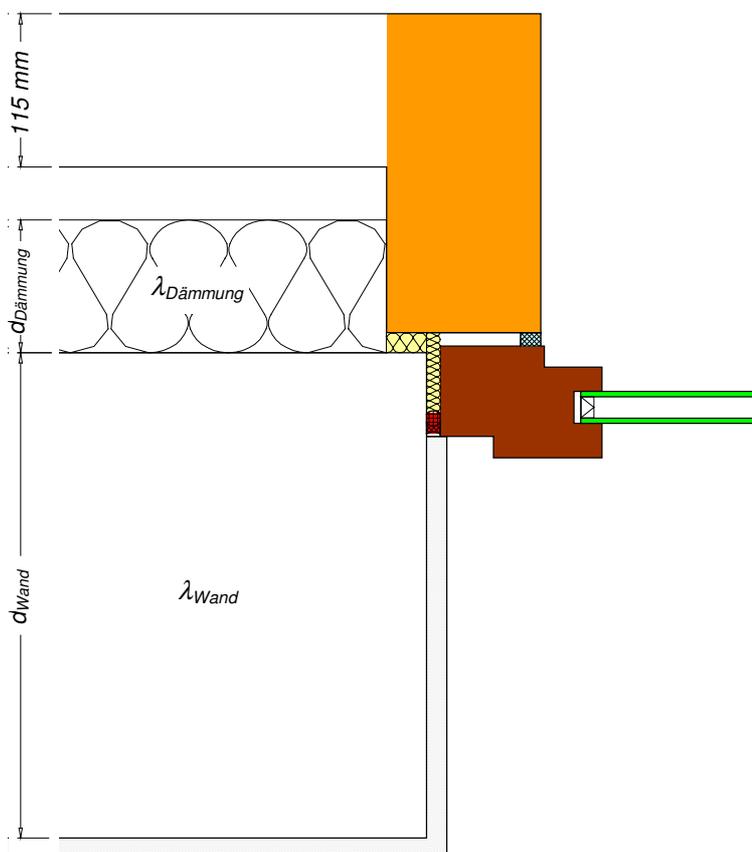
Seitlicher Baukörperanschluss eines Fensters an ein zweischaliges Mauerwerk mit Kerndämmung und Hinterlüftung, mit Innenanschlag, Einbaulage in Tragschale
